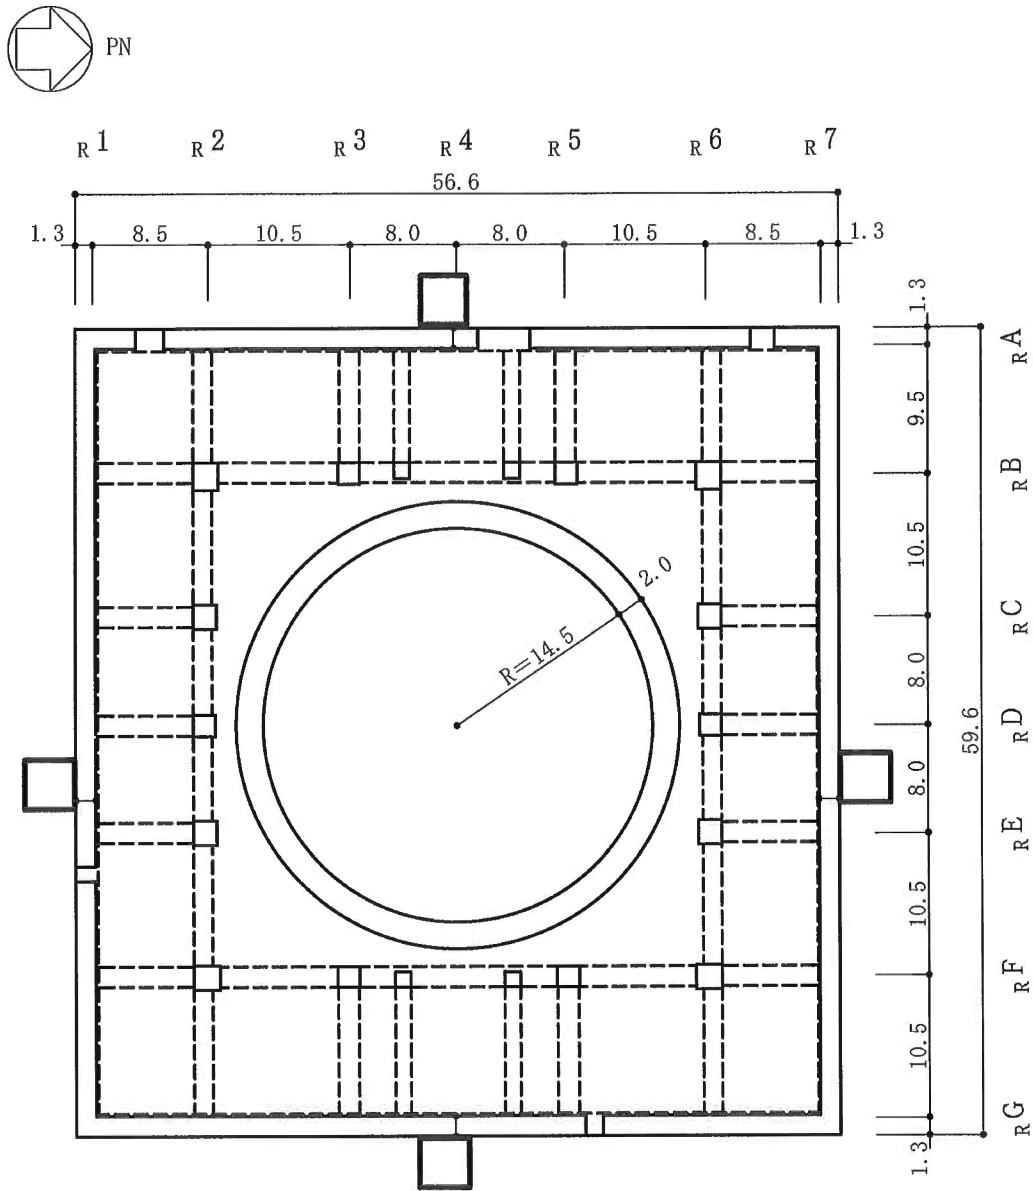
6号機原子炉建屋の概略平面図 (B2F, T.M.S.L. -1.7m) (2/9)
